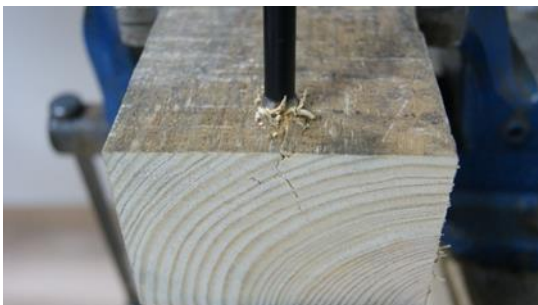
Fissuração do lenho durante a recolha.
